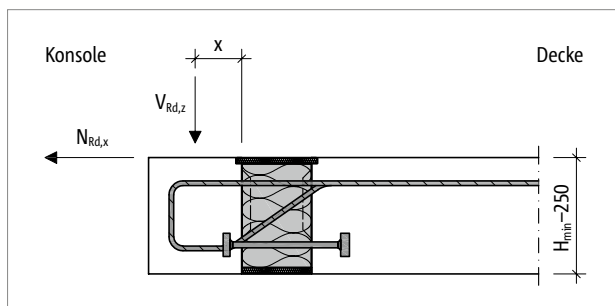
Schöck Isokorb® XT/T Typ O: Abstand des Lasteinleitungspunktes x (Lastabstand)
